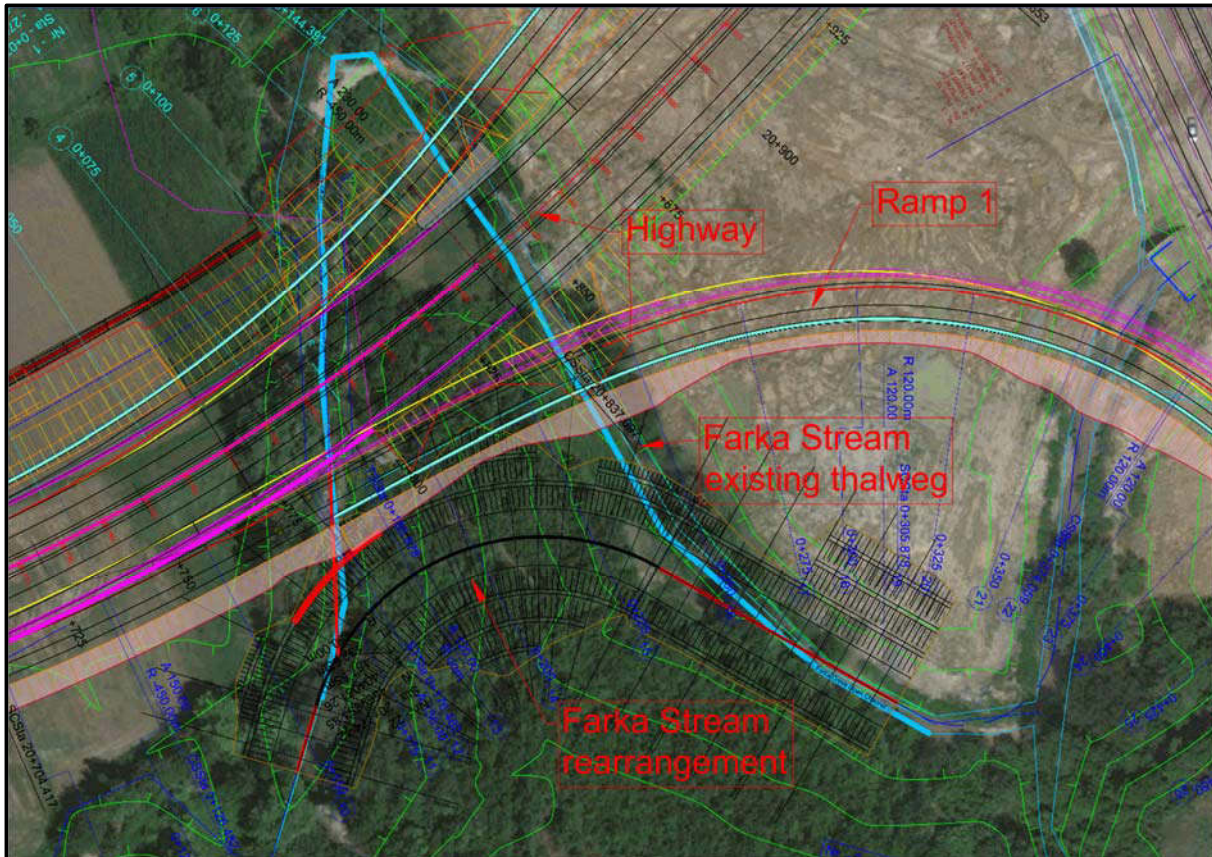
Pamje planare e prerjes së gjarpërimit të përroit të Farkës (riorganizim)
